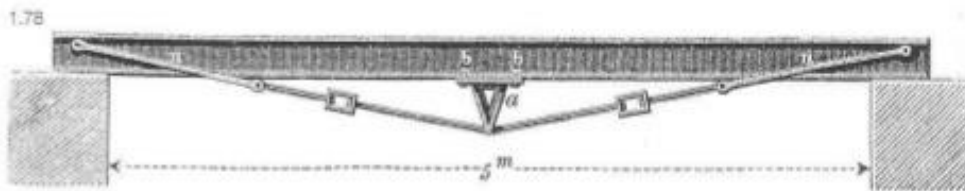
mecanismo de postesado en la parte inferior de una estructura existente, en el que el montante vertical será el encargado de transmitir las cargas a la viga mediante un esfuerzo de compresión.
